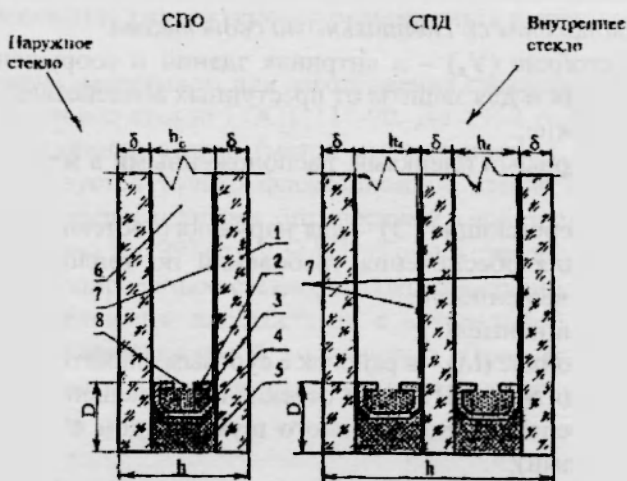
Типы и конструкции стеклопакетов (ГОСТ 24866-99):
